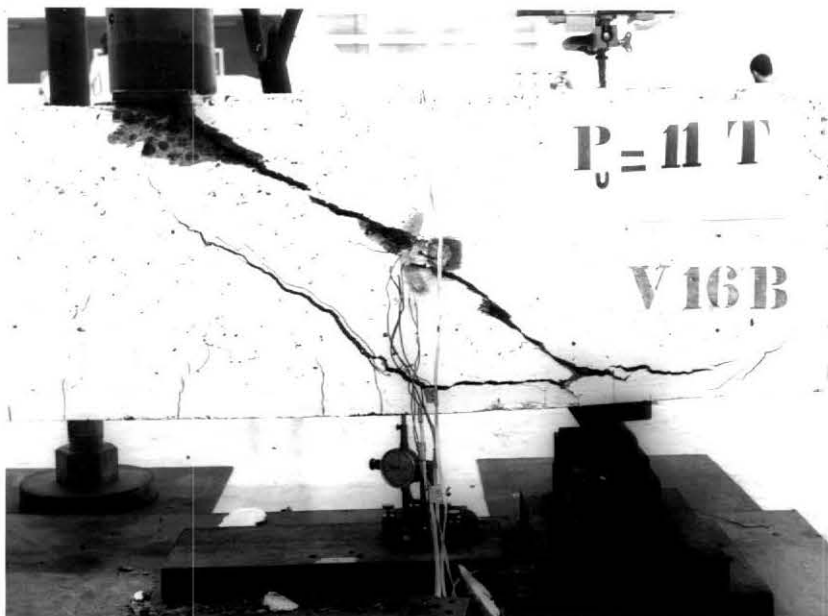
Detalhe da ruptura da viga 16B, notando-se o concreto esmagado sob a carga e a perda de ancoragem da armadura longitudinal
